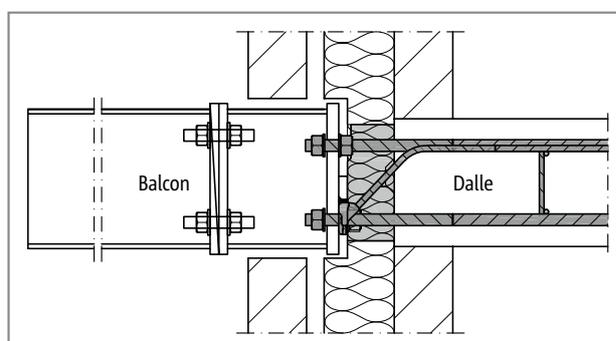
Schöck Isokorb® T type SK : Corps isolant dans l'isolation du noyau ; la pièce de liaison sur site entre l'élément Isokorb® et le balcon permet une certaine flexibilité dans le processus de construction
